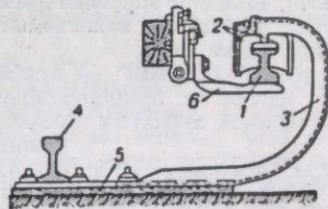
Установка контактного рельса: 1 — контактный рельс; 2 — изолятор; 3 — проштейн; 4 — ходовой рельс; 5 — шпалы; 6 — токоприёмник (башмак).
